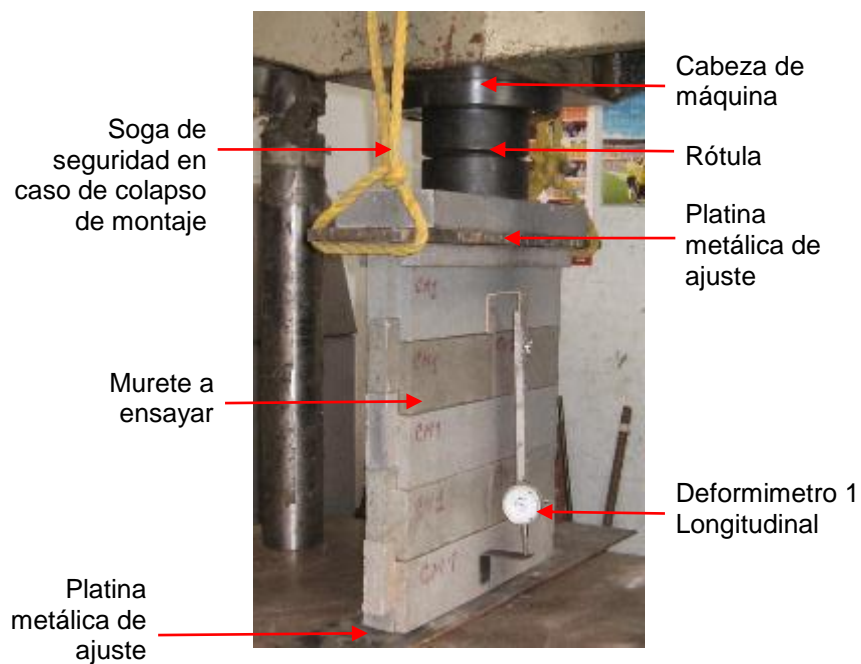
Montaje ensayo de compresión en muretes vista perfil. Fuente: Autor
